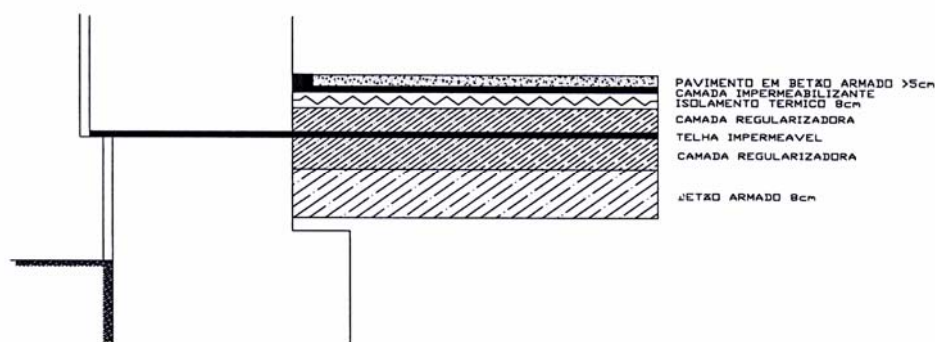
Impermeabilização de pavimento térreo com telas
